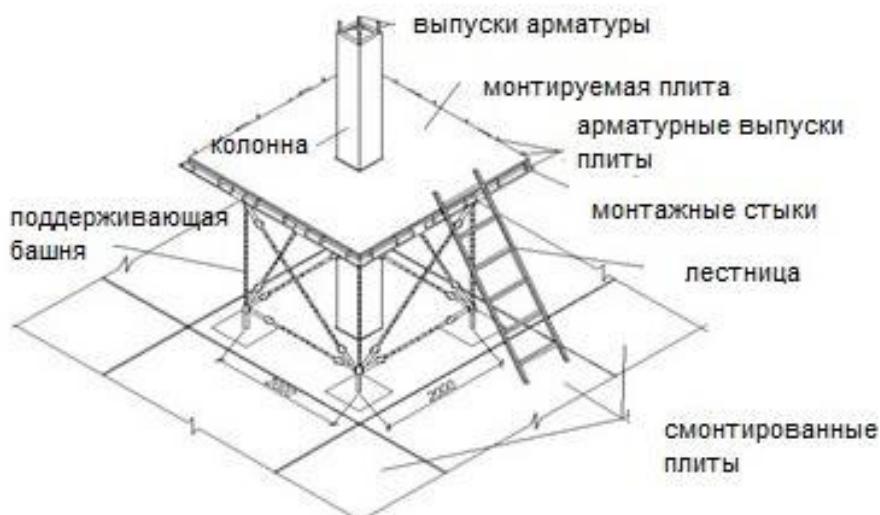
Монтаж надколонной плиты в строительной системе «КУБ 2,5»
